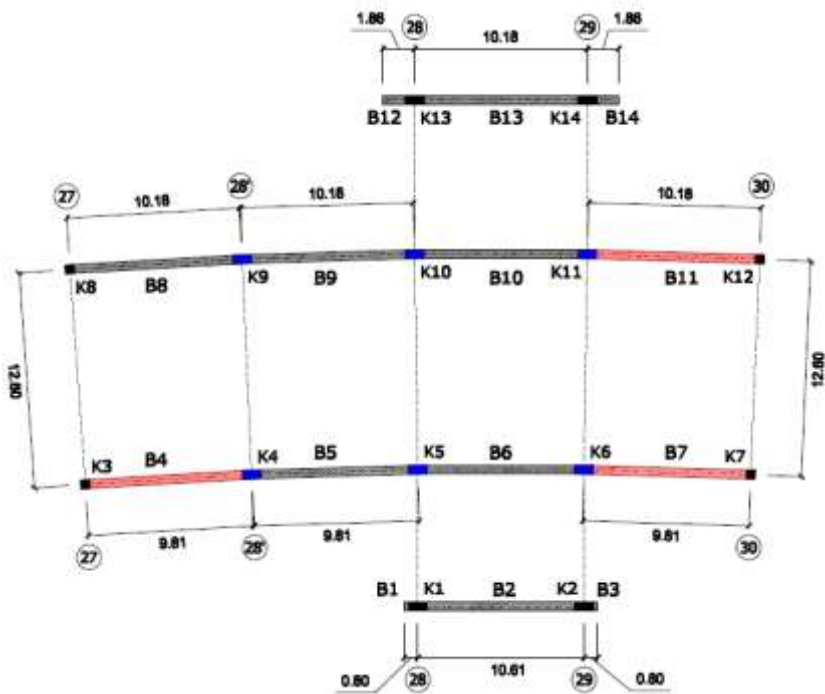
Lokasi Balok dan Kolom Terminal 1A Anjungan 1 Lantai 1 (Area : Breakdown)
